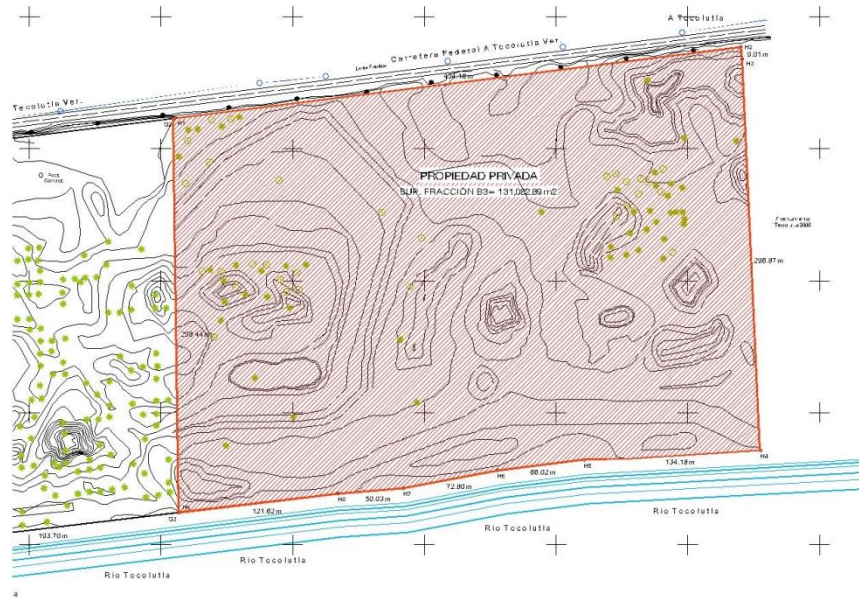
Croquis particular de nuestro sujeto de estudio. Fuente: Extracto del plano proporcionado por el vendedor.
